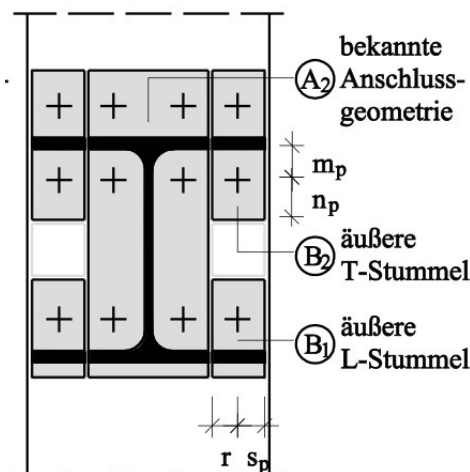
Stützen-Trägeranschluss mit 4 Schrauben pro Schraubenreihe [2]
